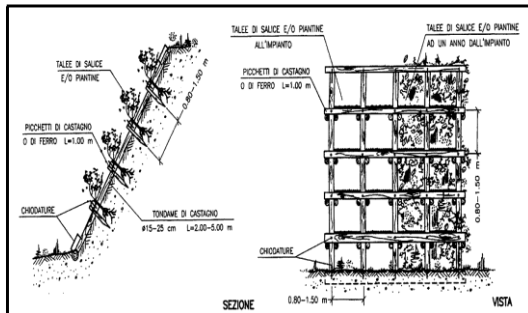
Técnica mixta. Esquema de sección y alzado de una espaldera (Fuente: Manual Regione Lazio) (EFIB, Paola Sangalli).
